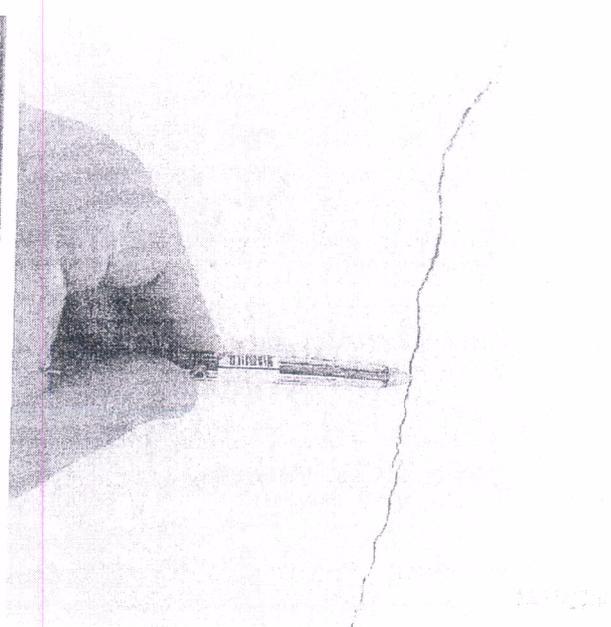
Fissuras próximas ao pilar do canto esquerdo da fachada da edificação
